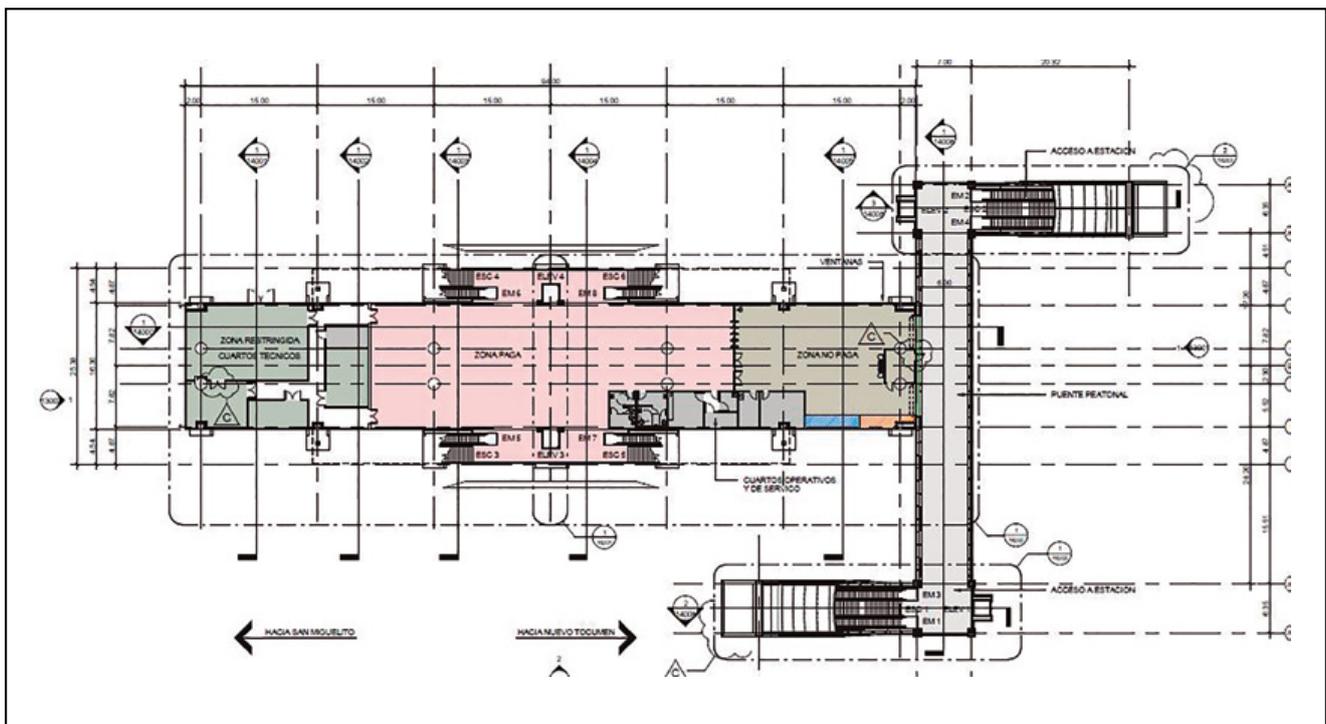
Planta típica del nivel vestíbulo de una estación de paso.
